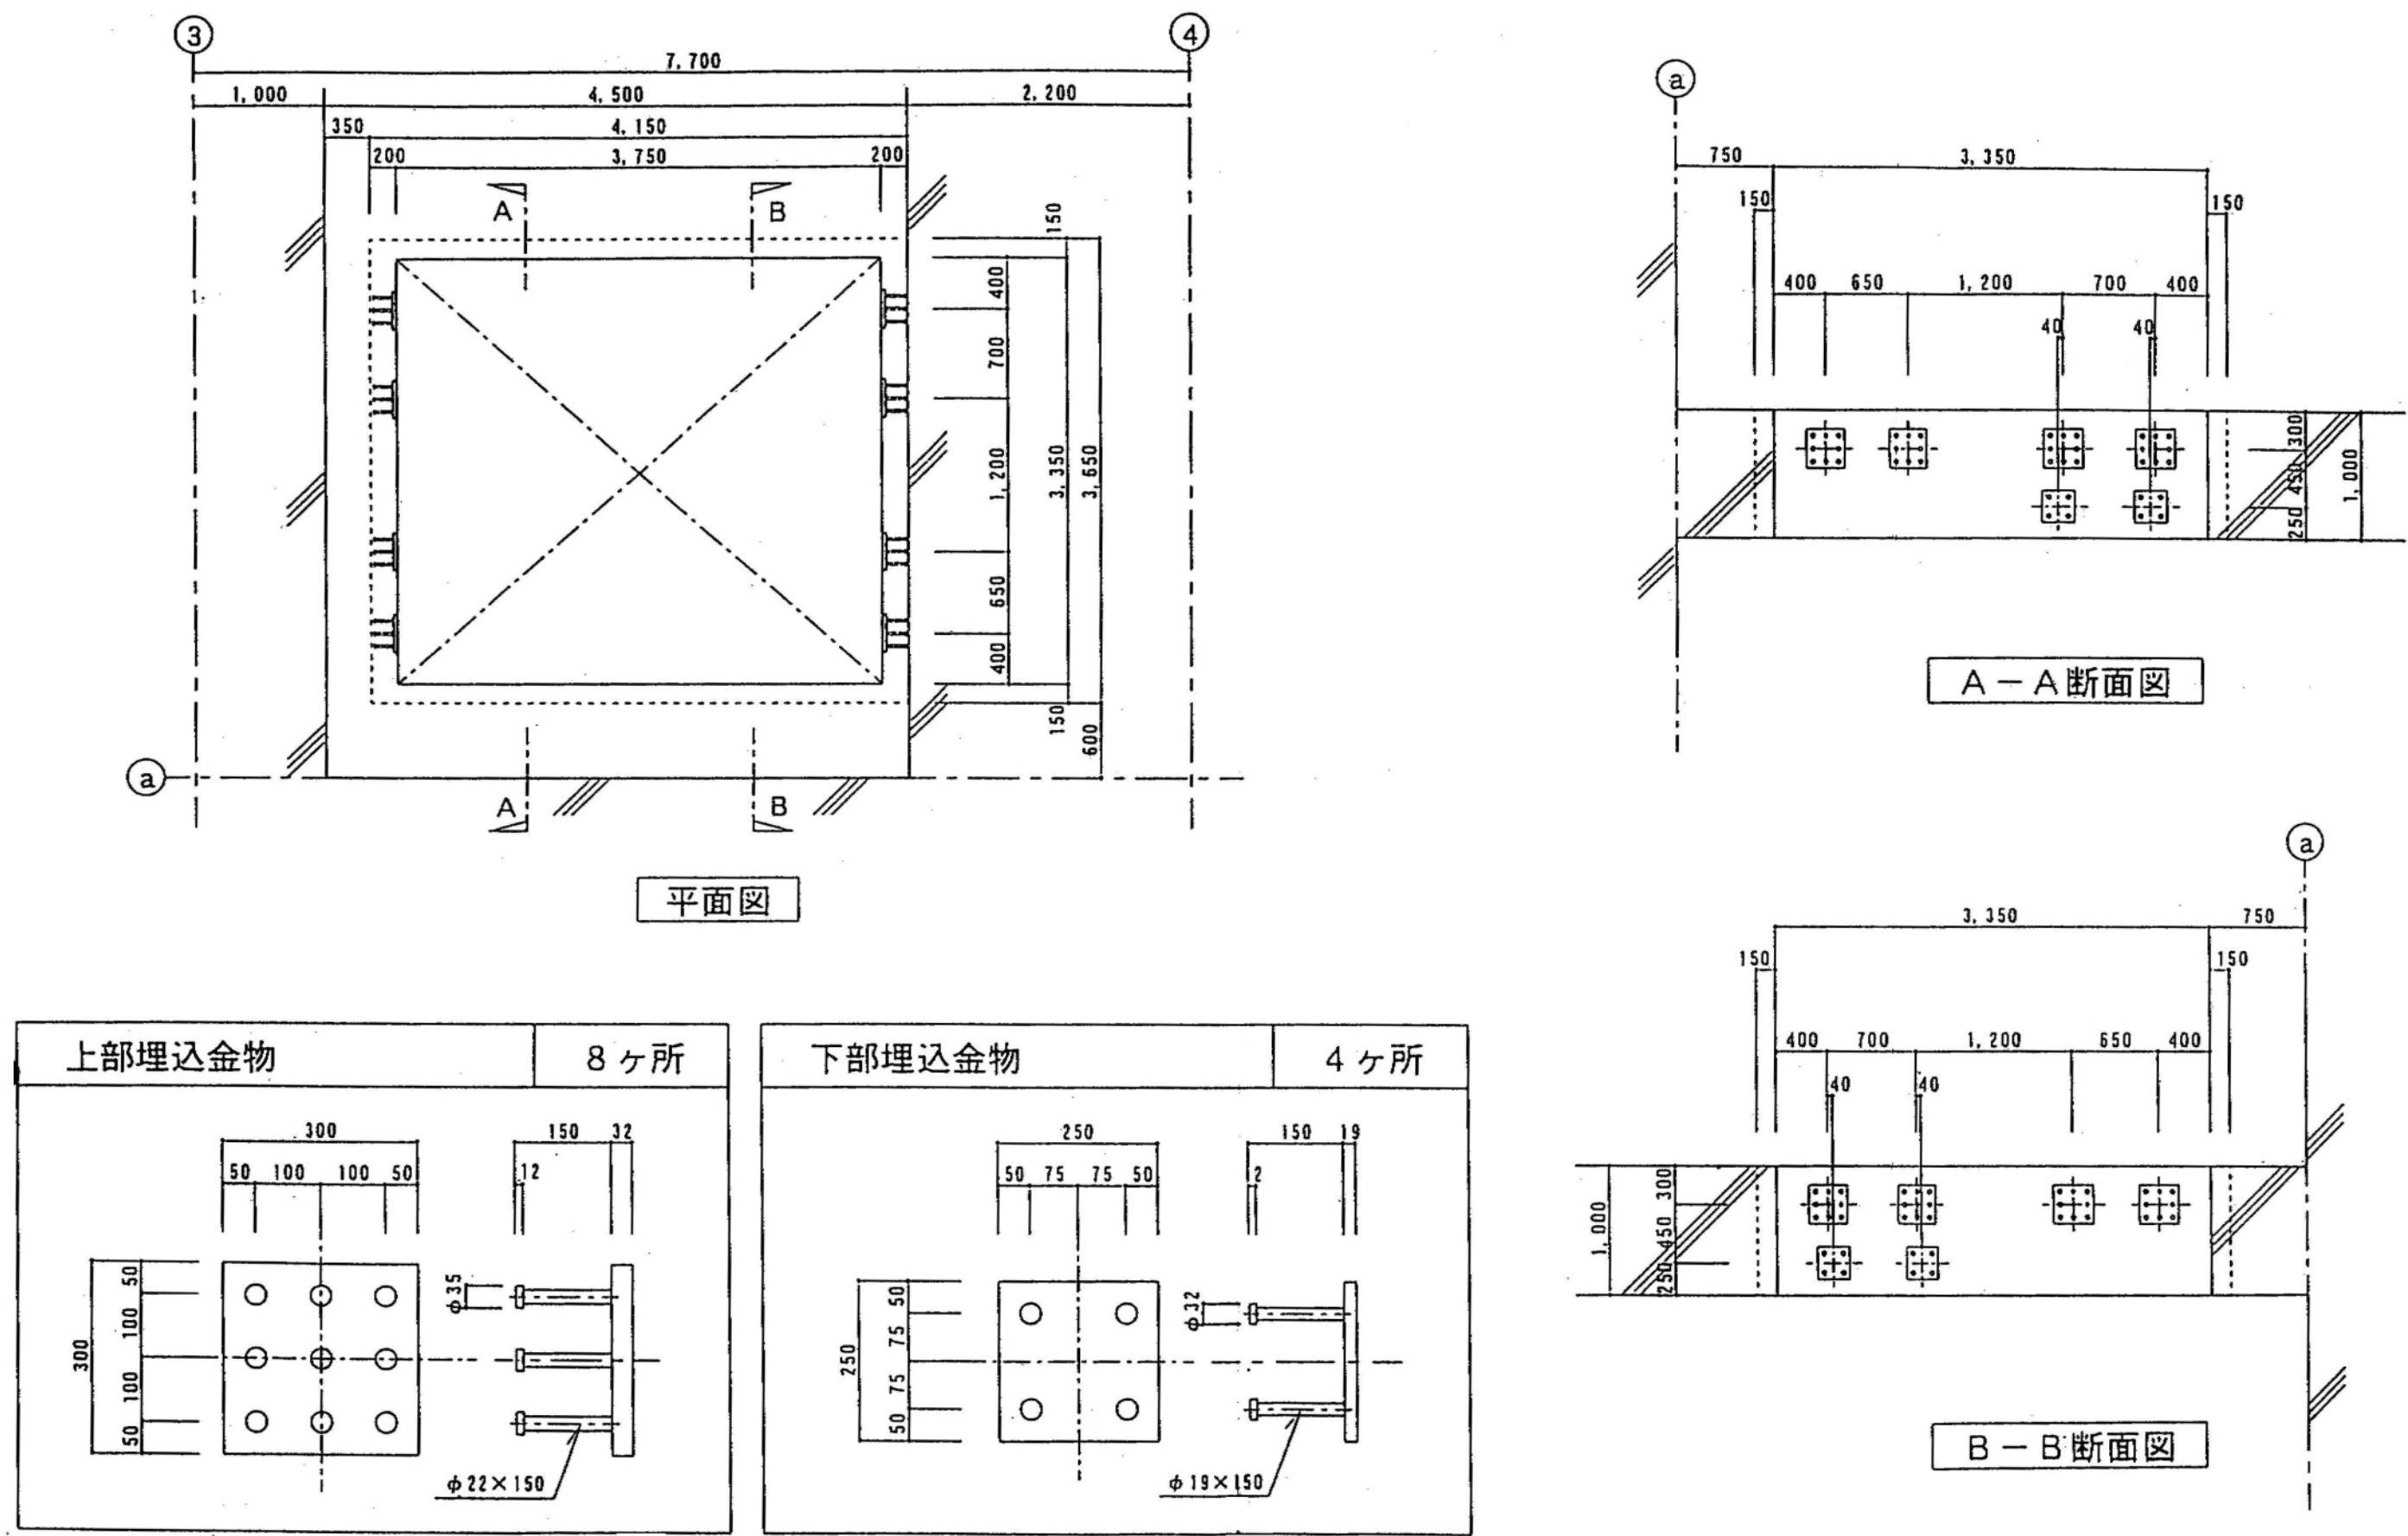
ポンプ洗浄室開口部拡大後の支持サポート用埋込金物配置図
